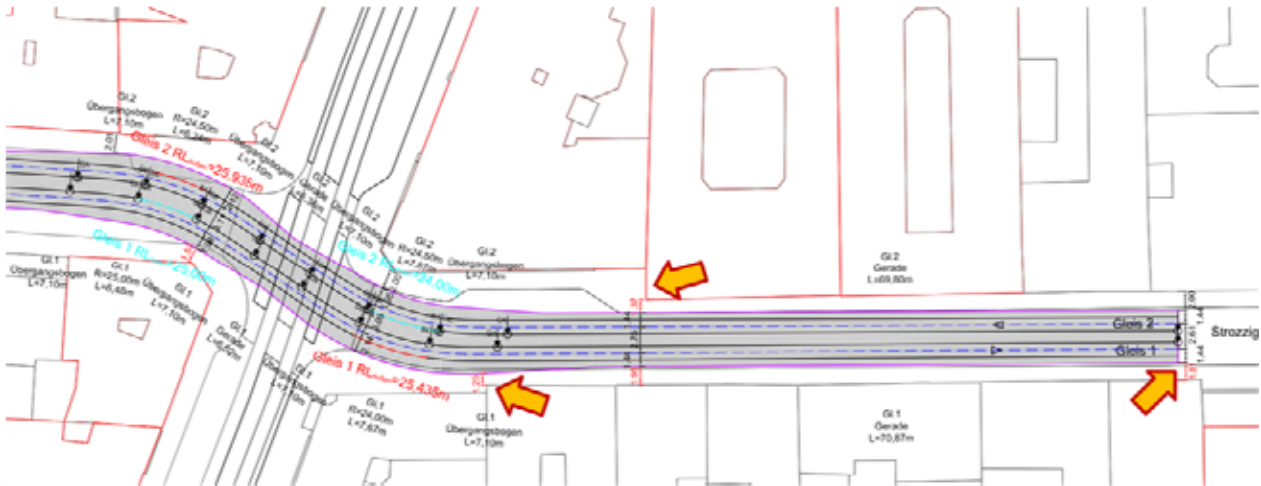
Lageplan Kreuzung Strozzigasse/Josefstädter Straße und Engstelle Strozzigasse, Darstellung für den kleinsten theoretisch möglichen Gleisachsabstand von 2,61m (von den Wiener Linien gefordert: 3,00m)
